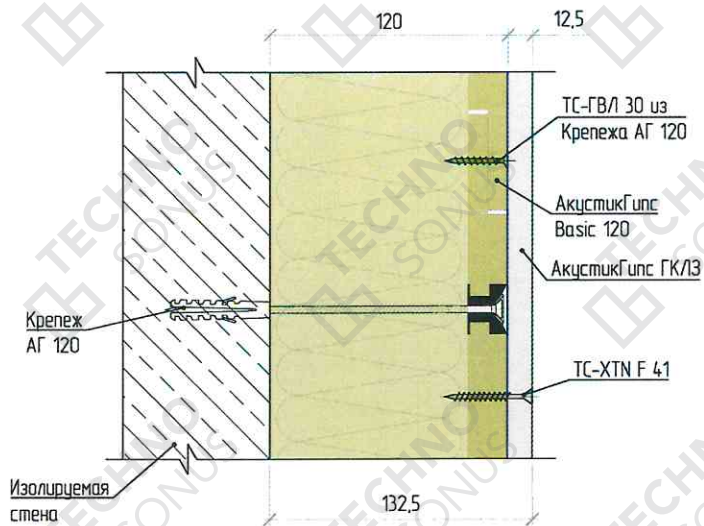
Конструкция бескаркасной системы звукоизоляции стены «Слим А3»
